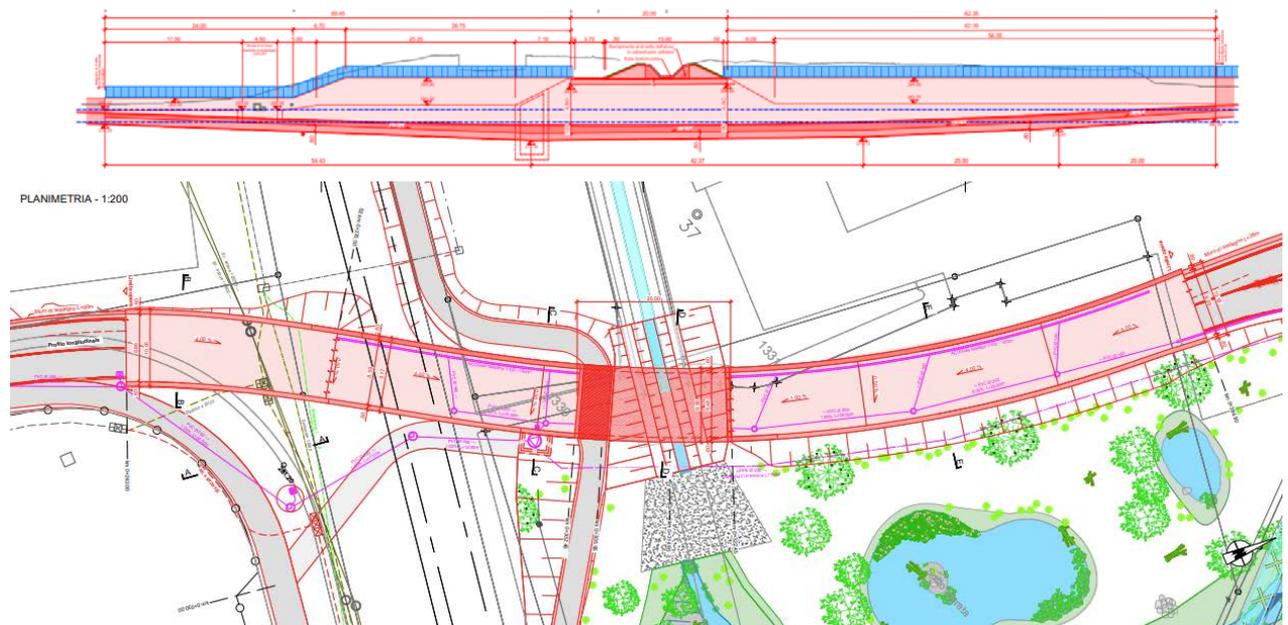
Planimetria e profilo longitudinale Sottopasso stradale Sottomurata
